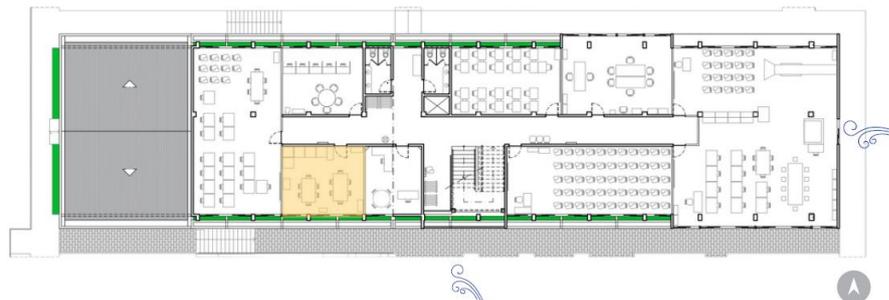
planta baixa do segundo pavimento do bloco CW, com destaque para sala estudada pela dupla (trabalho das alunas Adna Lacerda e Larissa Morais).
